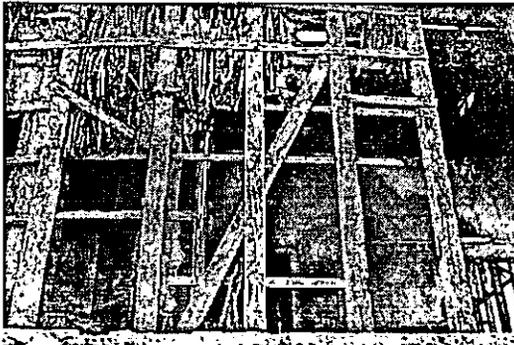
Daño termita en estructuras de vivienda. Carrizal Bajo
